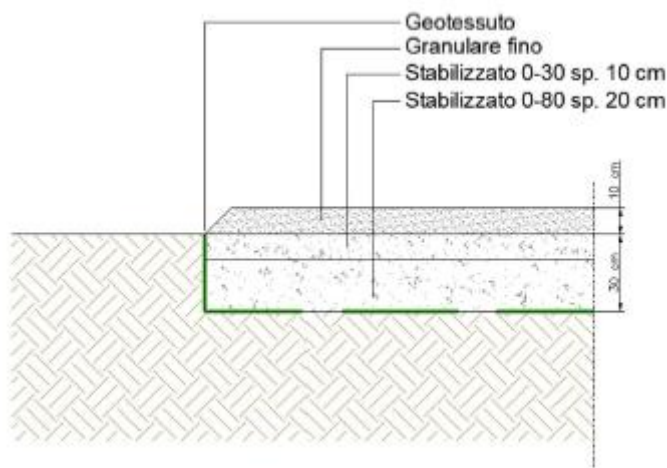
Sezione tipo viabilità interna dell'impianto e piazzali
